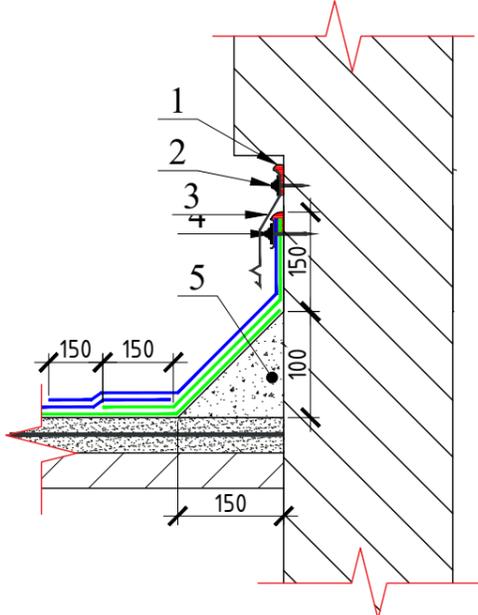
Состав покрытия крыши помещения выхода на кровлю
